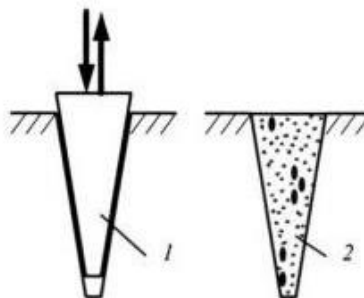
Влаштування набивної палі у виштампованому ложі: 1 – виштамповане ложе; 2 – бетонна суміш
